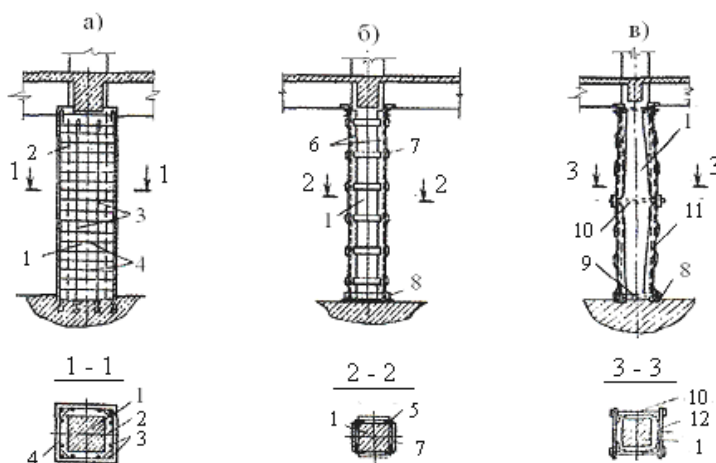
Способы усиления железобетонных колонн: а – железобетонной обоймой с обычной арматурой; б – металлическим каркасом; в - двусторонними металлическими распорками:
